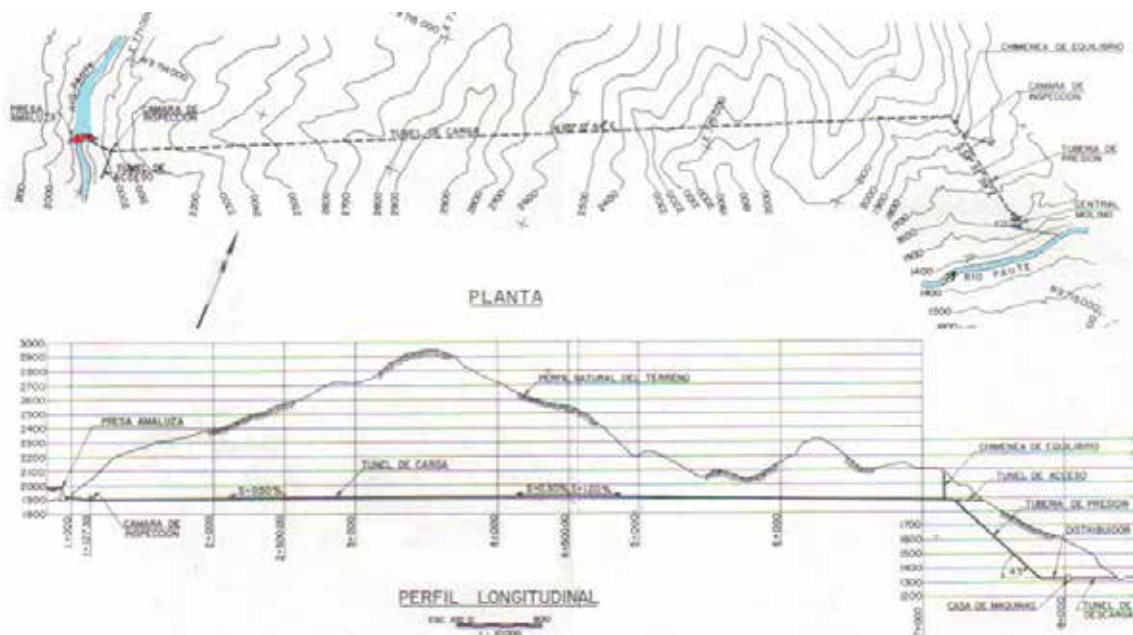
Vista en planta y perfil longitudinal del proyecto Paute. Fuente: INECCEL (1979)
